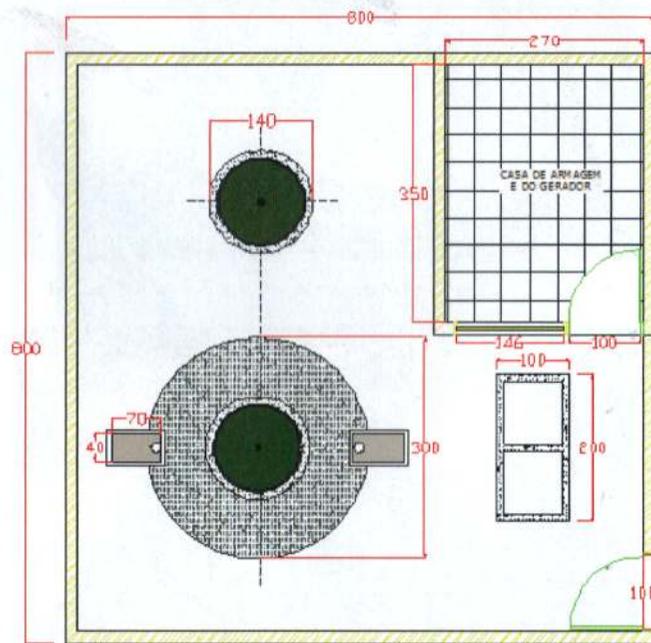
Planta completa do sistema de biogás PUXTIL de 6 m³
